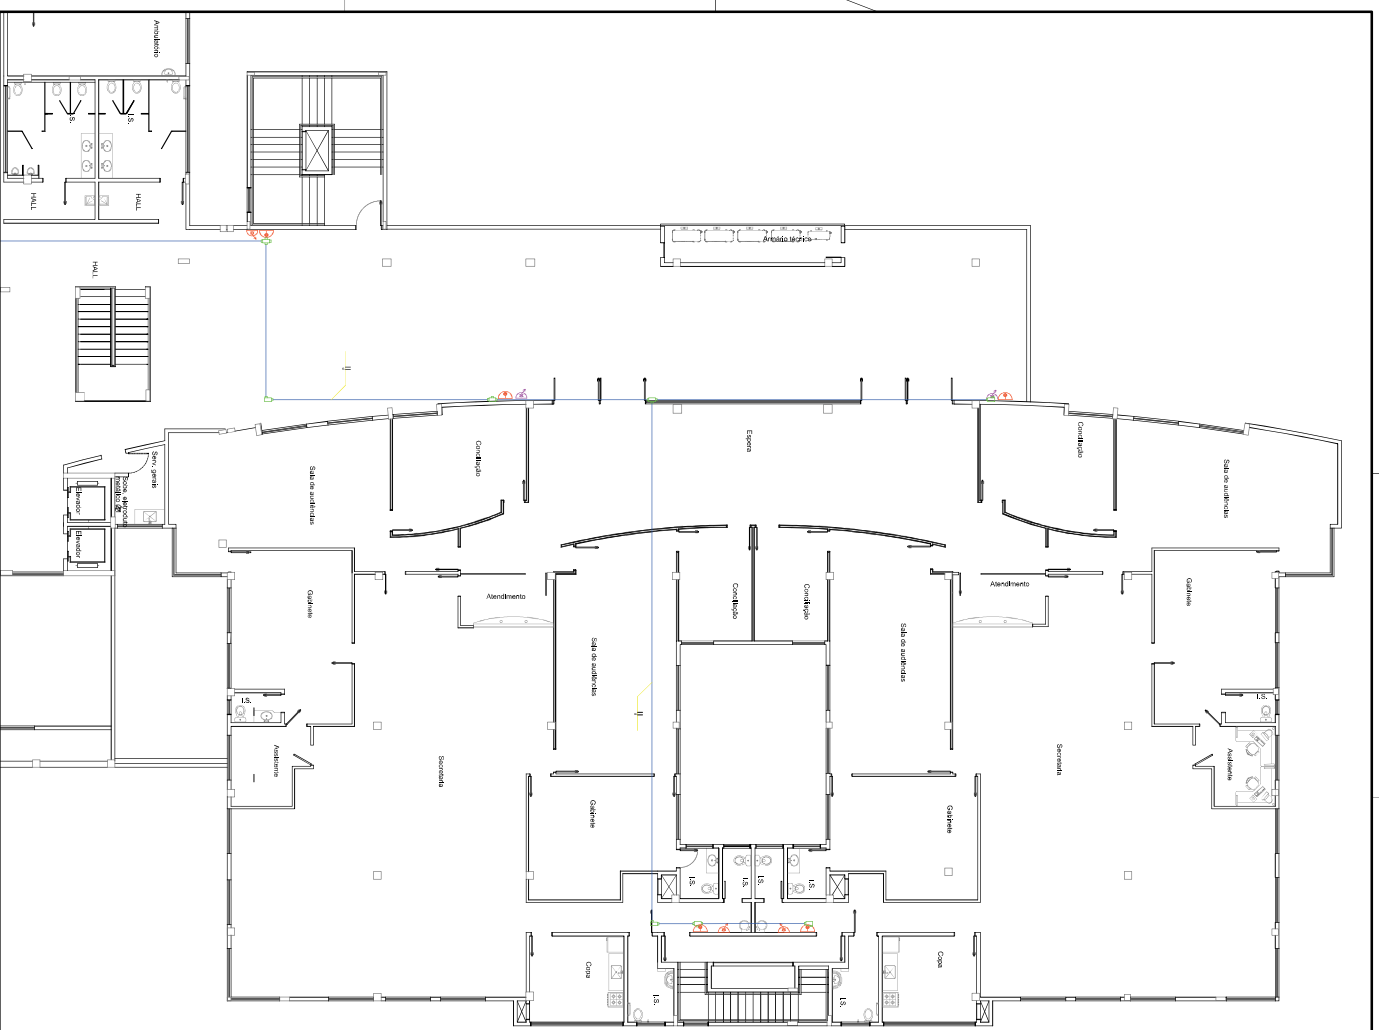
2º pavimento - sala de audiências - corte de elevação
